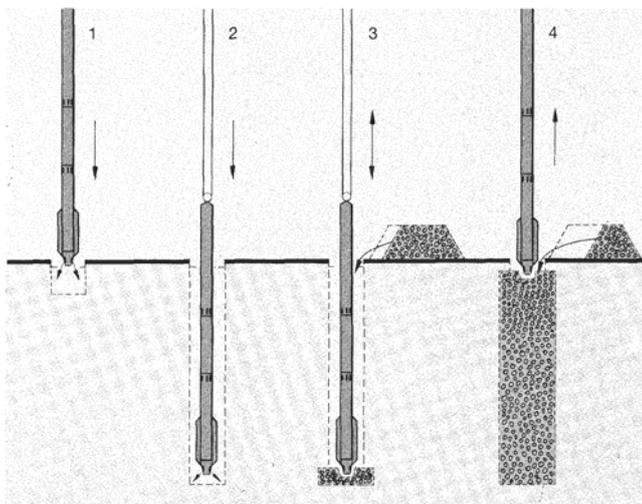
Herstellungsphasen Rütteldruckverdichtung [8]
